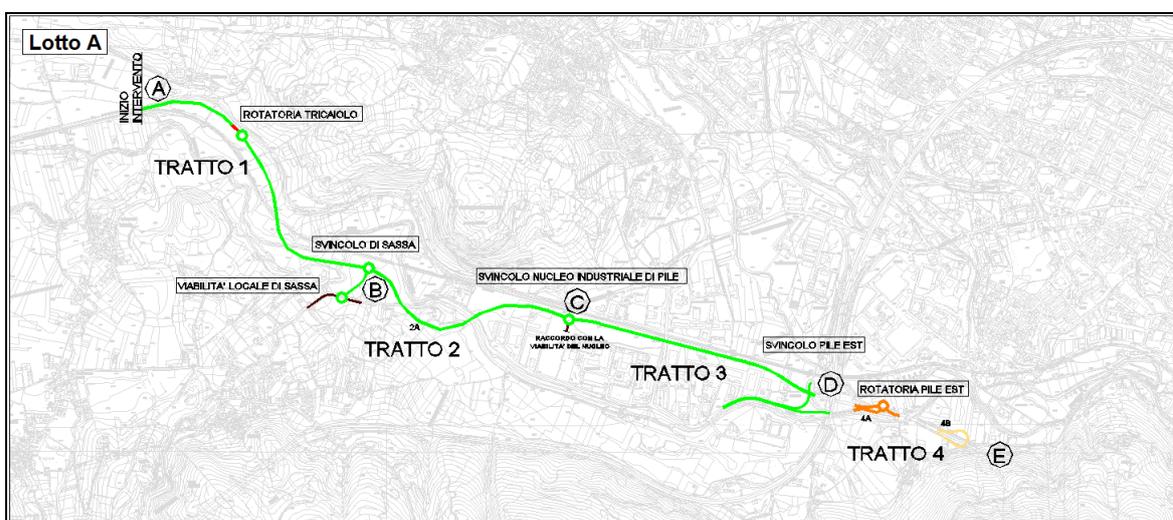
Lotto A: tracciato principale (in verde) ed alternativa di progetto 4B (in giallo)
